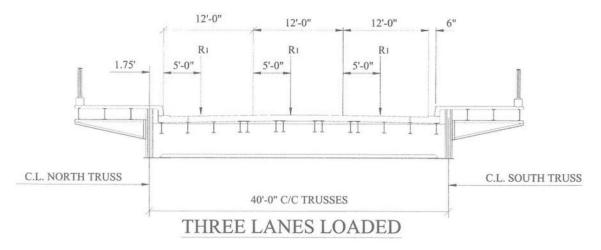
Colocación de carga para distribución hacia la armadura norte
